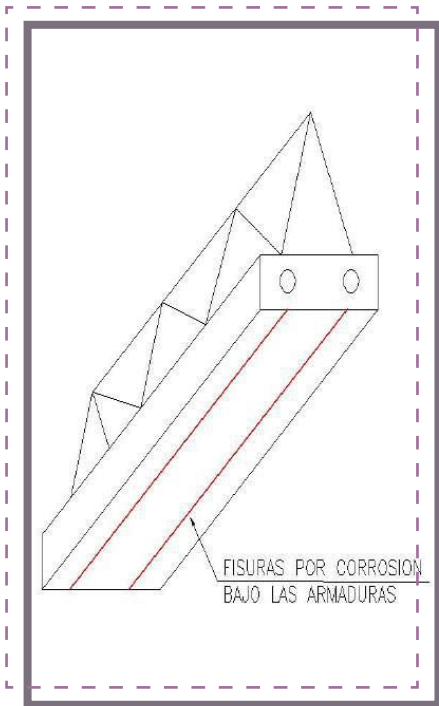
Esquema de las fisuras en vigueta de hormigón armado por corrosión de las armaduras.
